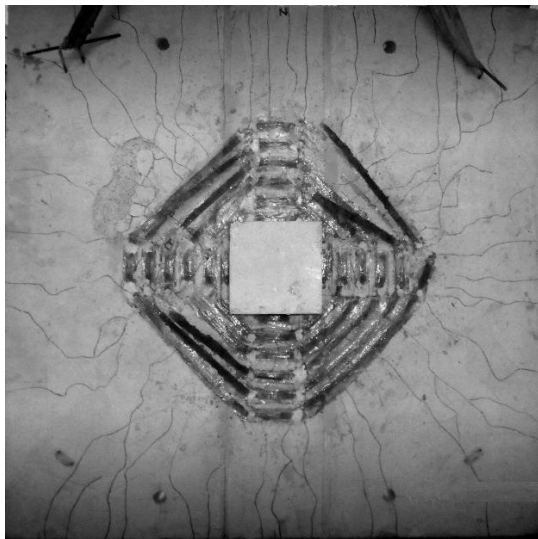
Padrão de Fissuração - LC-S2
